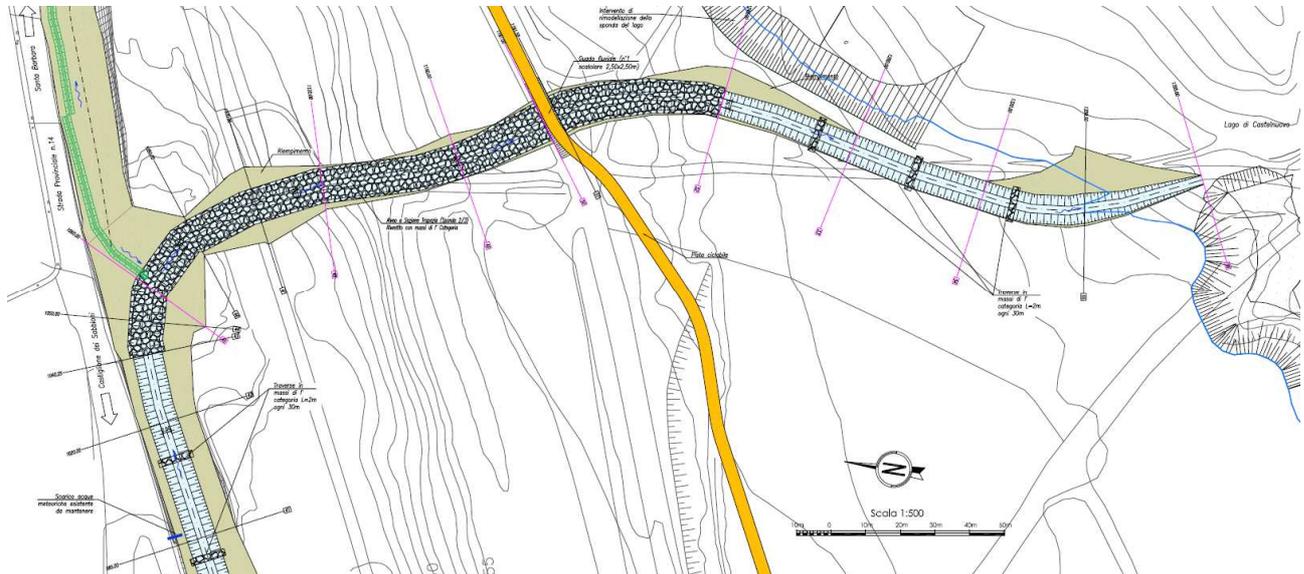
Planimetria tratto 3 di 3 di risagomatura del borro Lanzi
